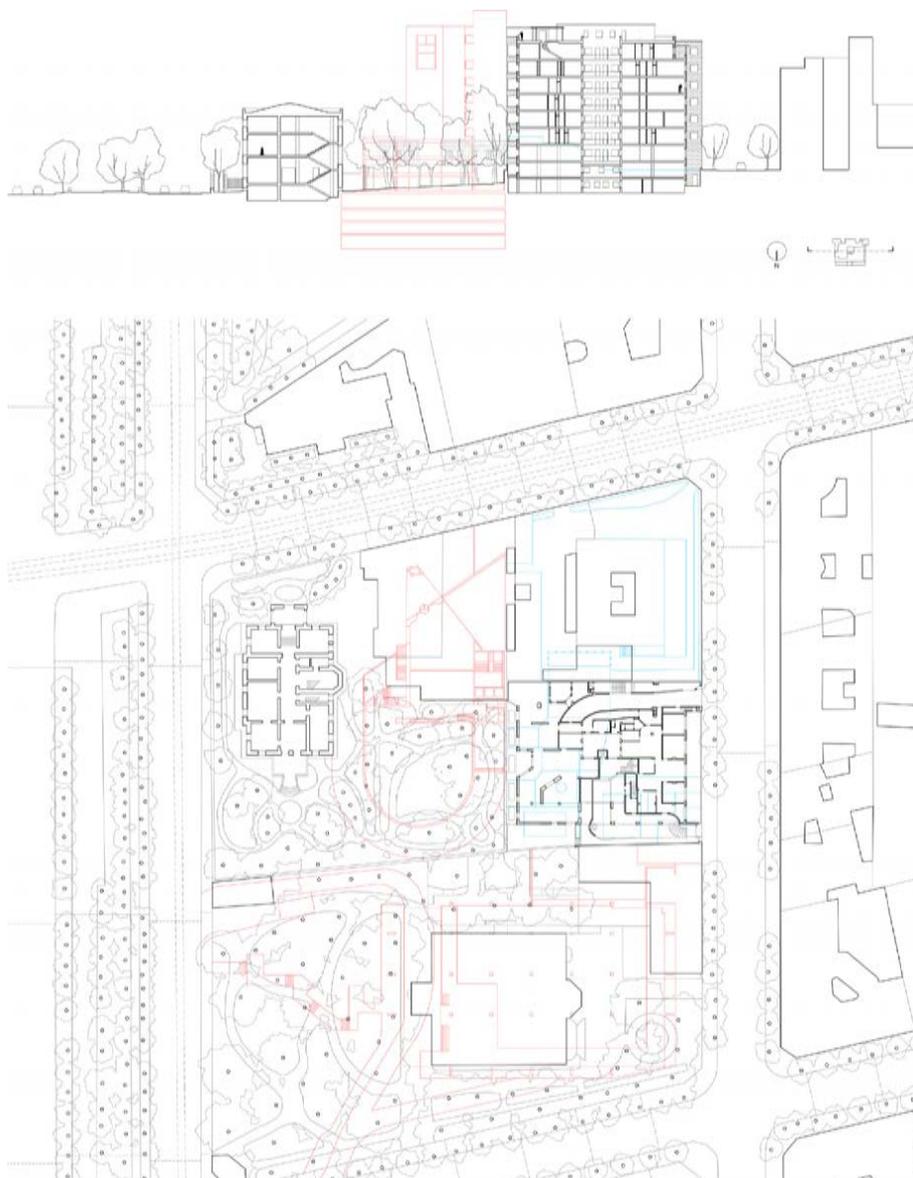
Planta baja y sección general de la manzana. En rojo, arquitecturas posteriores a Fortuny 14; en azul, las anteriores. Elaboración propia.
